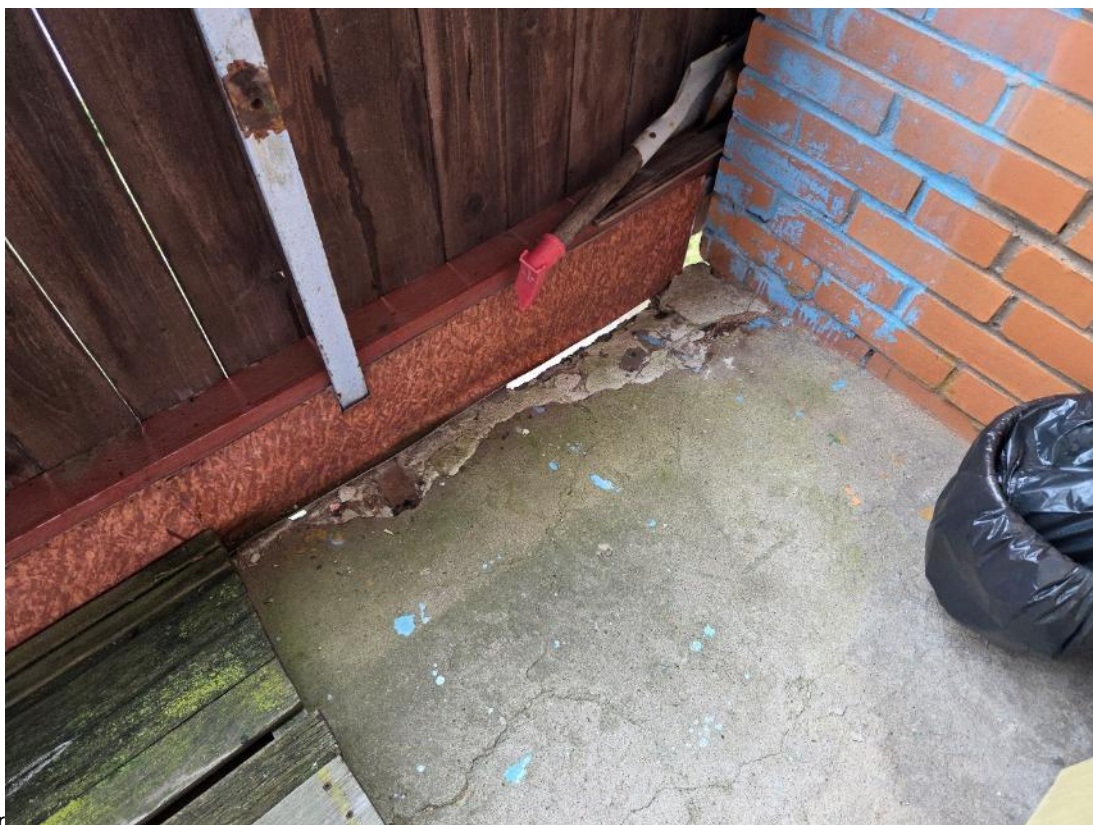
Lodžal on betoon murenenud, raud on paljandunud ja korrodeerunud.
